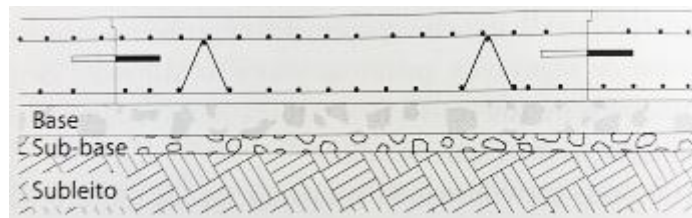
Pavimento de Concreto Estruturalmente Armado
